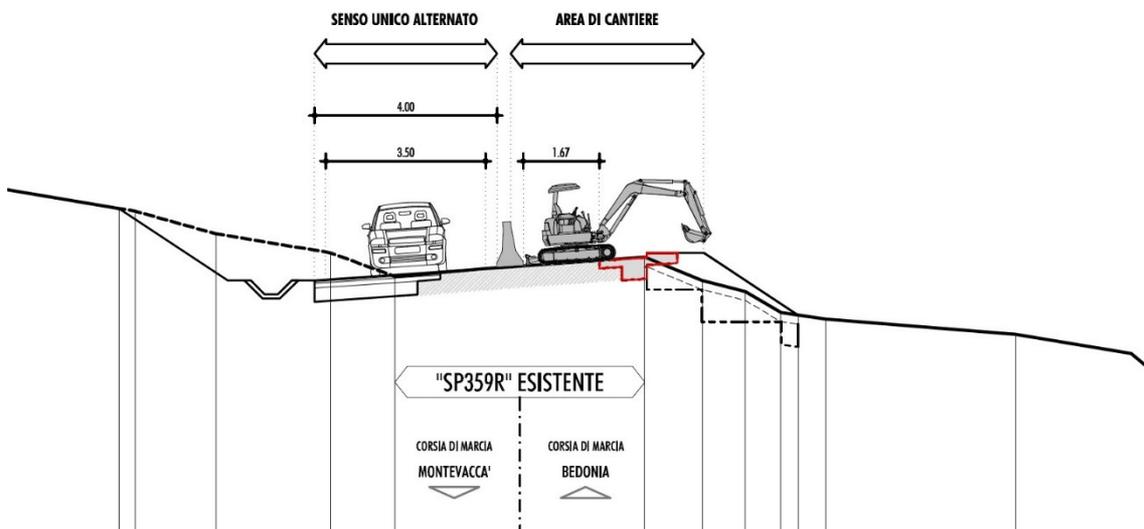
TRATTO 2, FASE 3: TRAFFICO SU CORSIA DI MONTE (ESTRATTO DALL'ELAB. PD.04.04)
